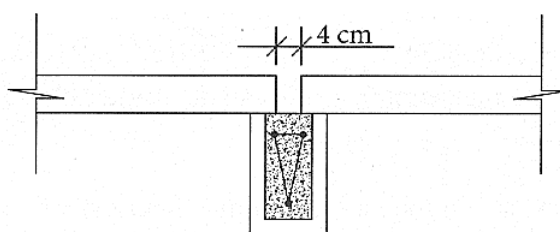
Opção para detalhe contra colapso progressivo em painéis de lajes pré-moldadas sem ligação entre estes. Fonte: Parsekian (2012).
